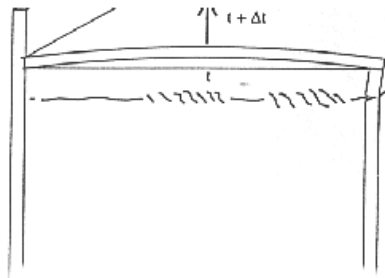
TRINCA NA PAREDE movimentação térmica da laje
